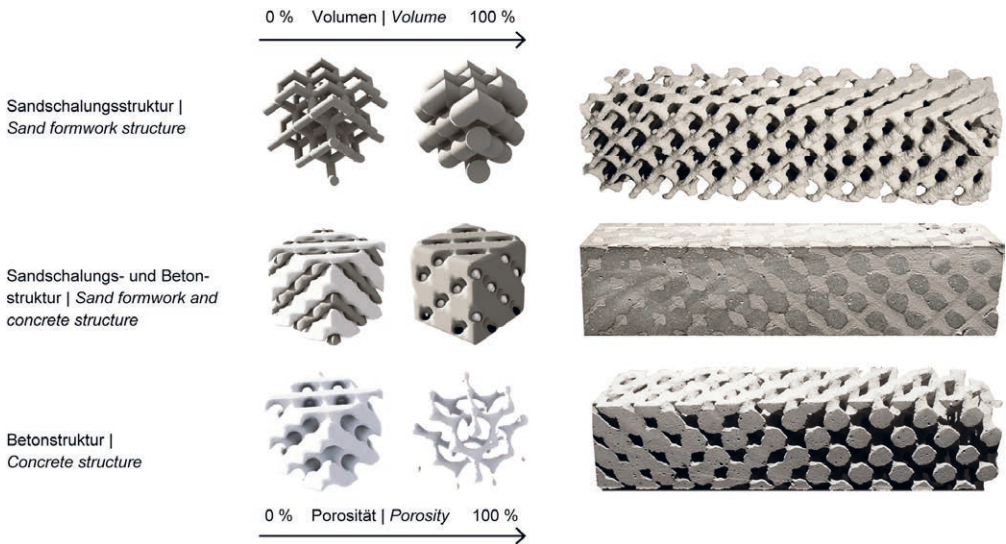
Modellierung von räumlichen Rahmenkonstruktionen aus Sand (Schalung) und Beton und produzierte Proben aus Sand (Schalung) und Beton | Fig. 1: Modelling of sand (formwork) and concrete spatial frame structures and produced sand (formwork) and concrete graded specimens | Source: Daria Kovaleva
